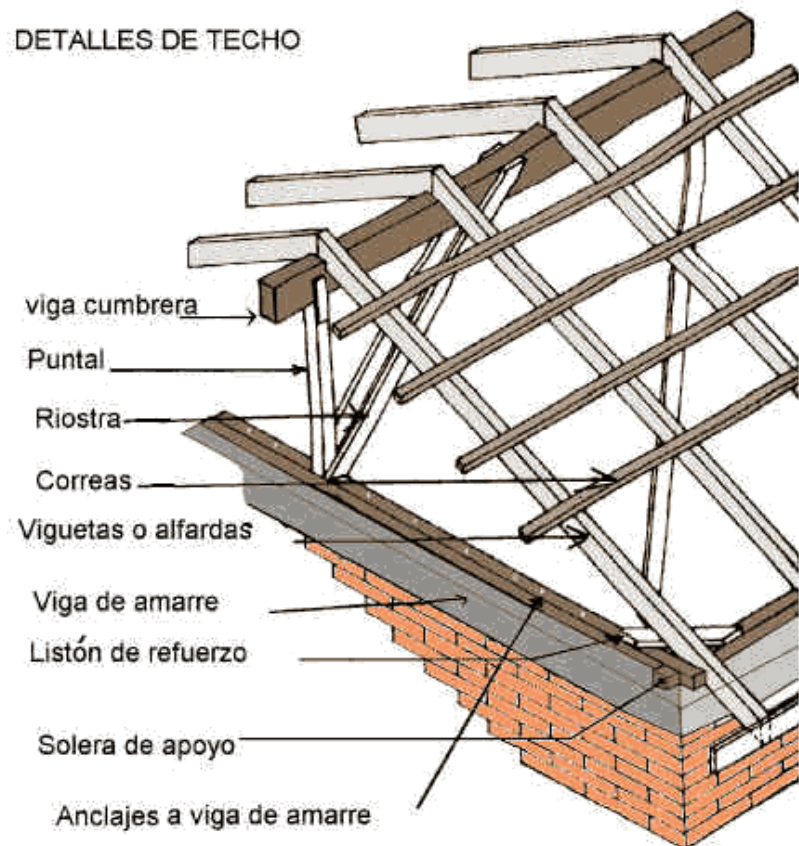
Detalles techo - Fuente: Blog spot/cubierta
